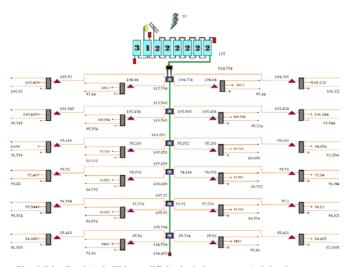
Distribución de TV en edificio de 6 alturas con 4 viviendas por planta
